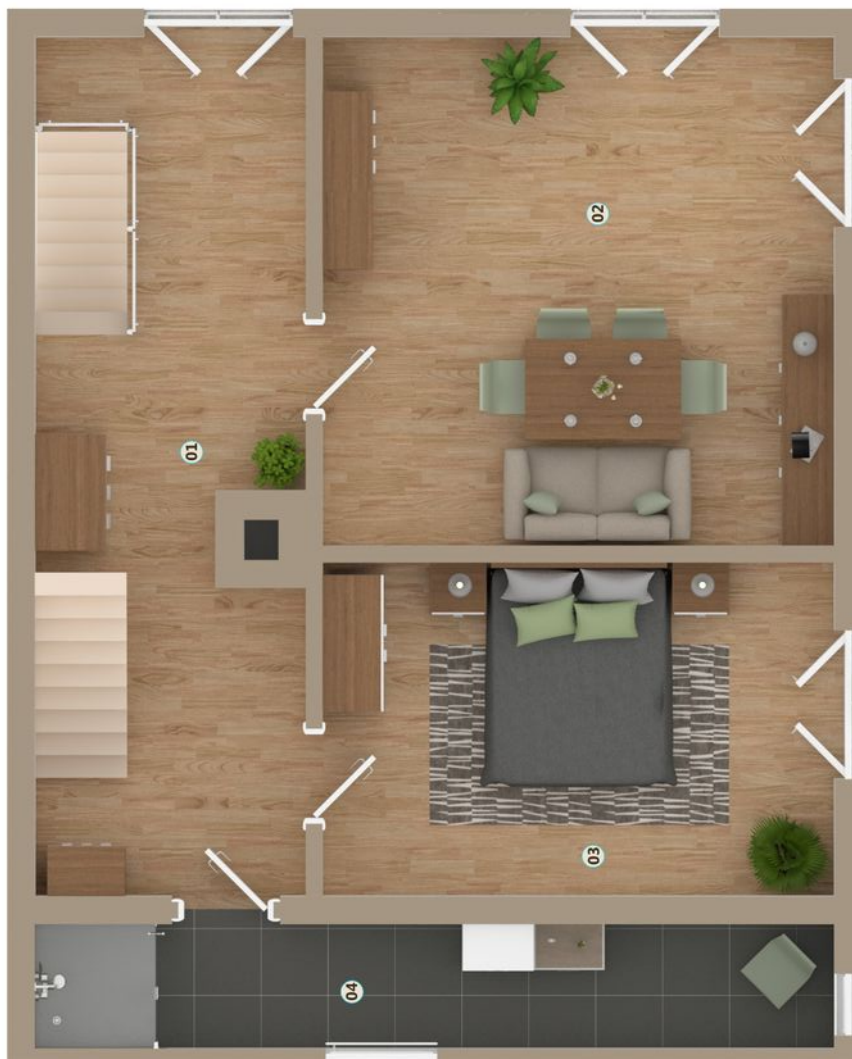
Grundriss Obergeschoss mit Treppe ins Dachgeschoss
